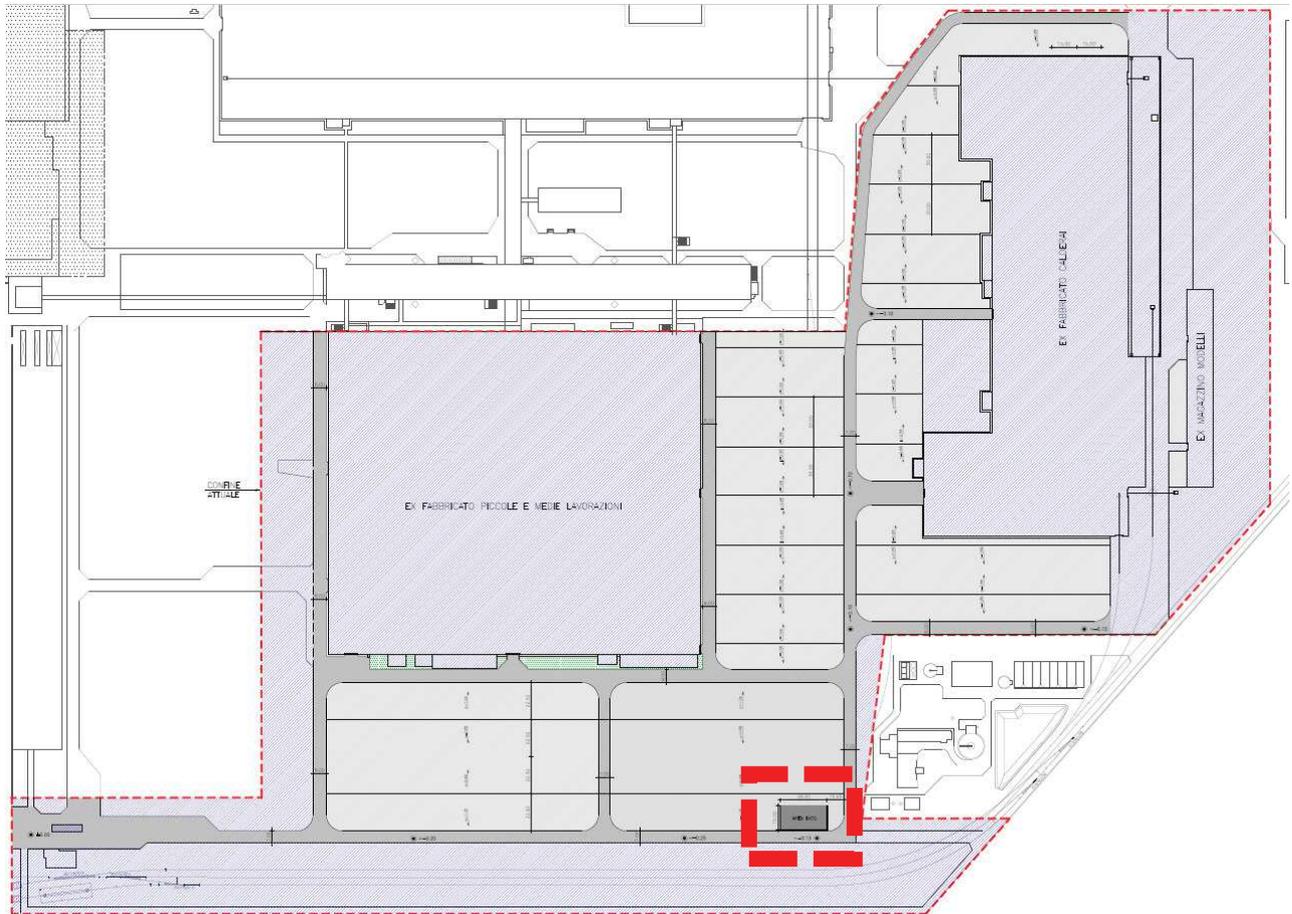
Planimetria dell'area in oggetto dell'intervento con evidenziato in rosso l'area IMDG
